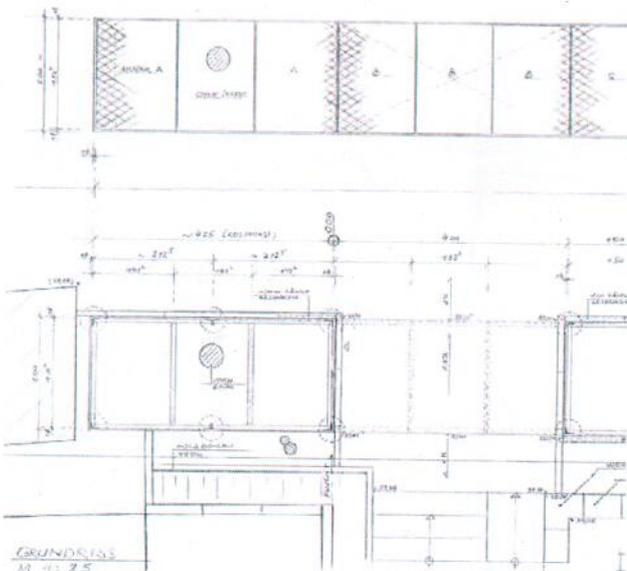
Grundriss und Detail einer abstrakten Nachbildung in Form eines Rankgerüsts am Hamtor als Beispiel für die Nachbildung am Bluturm.
